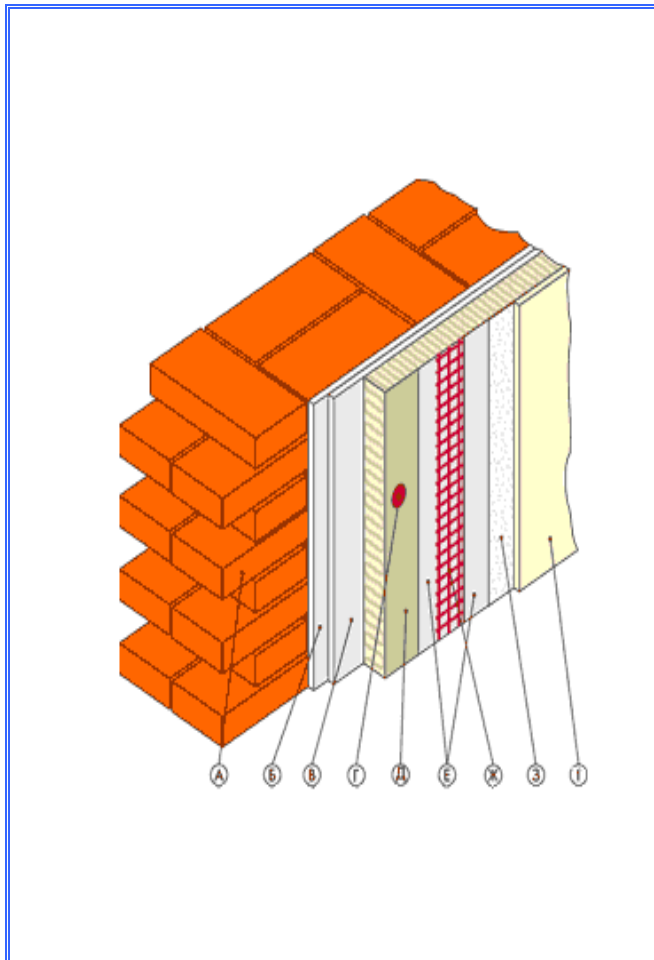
Утеплення фасадів штукатурним способом: А – несуча стіна (бетон, легкий бетон, цегляна або кам'яна кладка, дерево, метал); Б – старе зовнішнє опорядження (штукатурка і т.п.); В – спеціальний мінеральний клейовий склад; Г – спеціальний фасадний дюбель; Д – плити утеплювача (базальтове волокно або пінополістирол); Е – базовий шар із клейового мінерального складу; Ж – лугостійка сітка із скловолкна; З – акрилатна ґрунтовка з кварцовим піском; І – декоративна штукатурка
